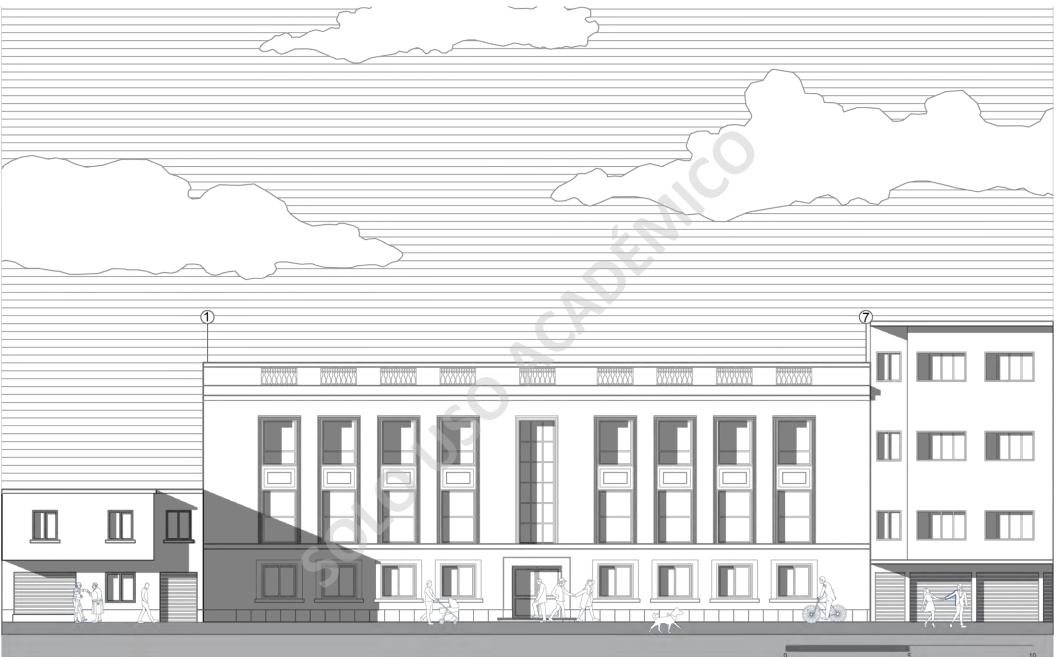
Fachada Frontal, Inmueble Seleccionado.
